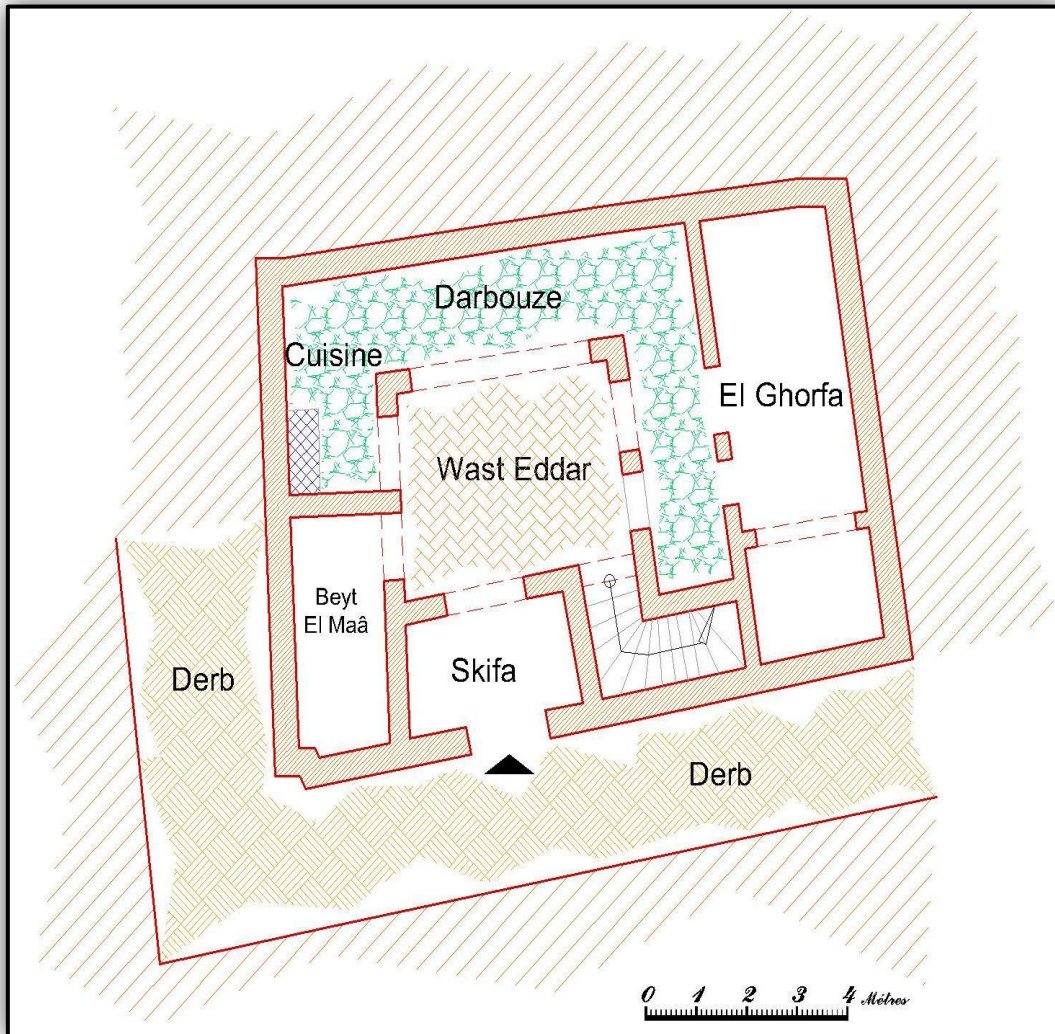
Plan du rez de chaussée de *Dar Tchouar*.
